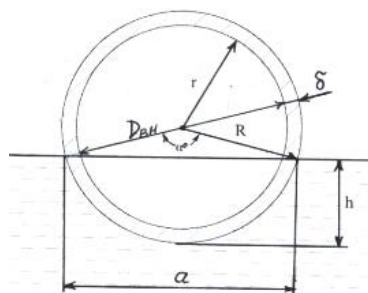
Поперечное сечение железобетонной трубы, погруженной в раствор
